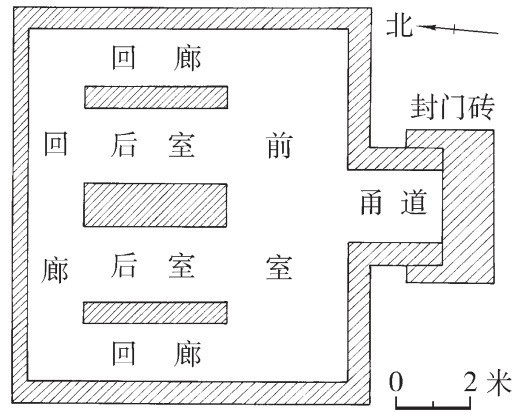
江苏省邳江甘泉 2 号墓平面图 (1/200)
